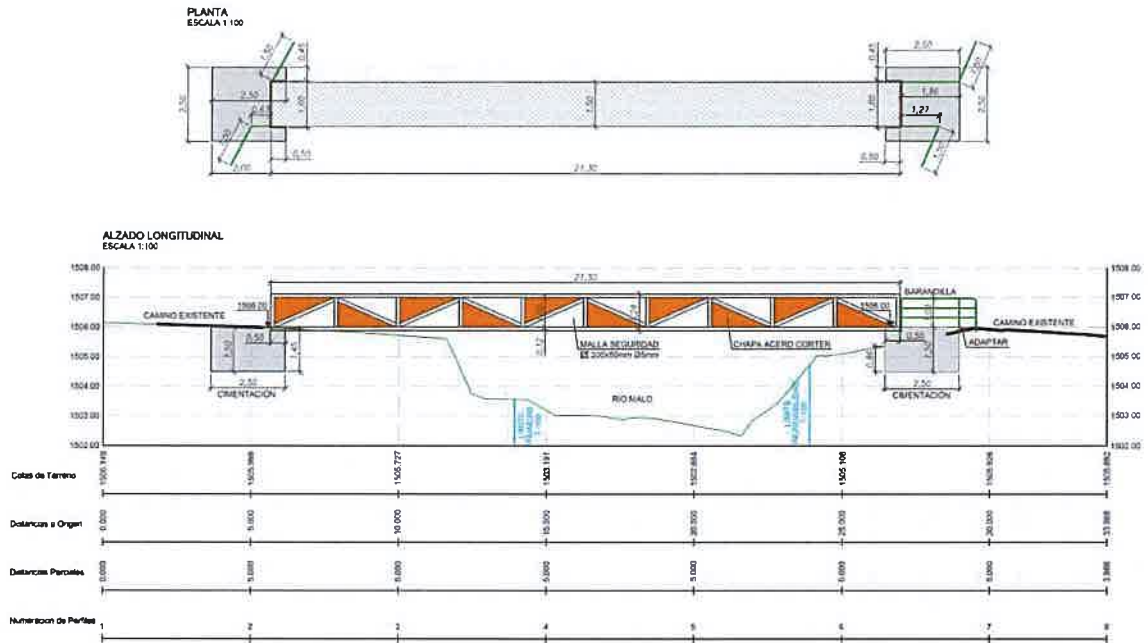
Planta y alzado longitudinal de las pasarelas.
